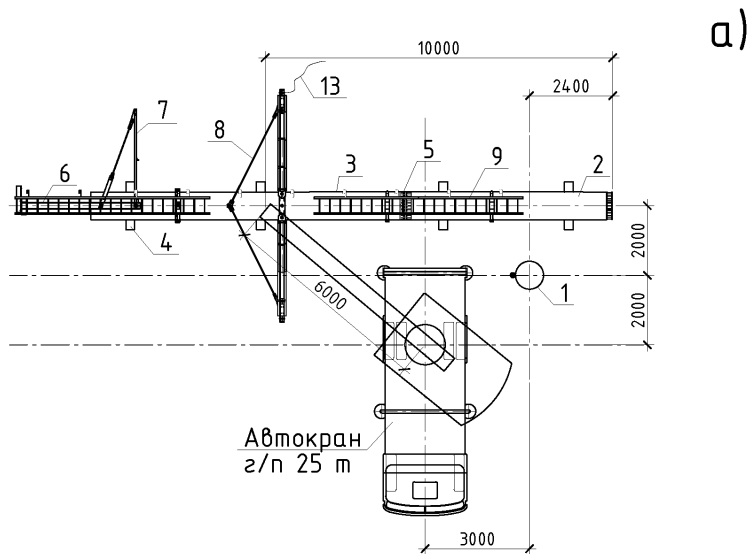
Схема сборки и монтажа опоры СУБ110-1Ф
